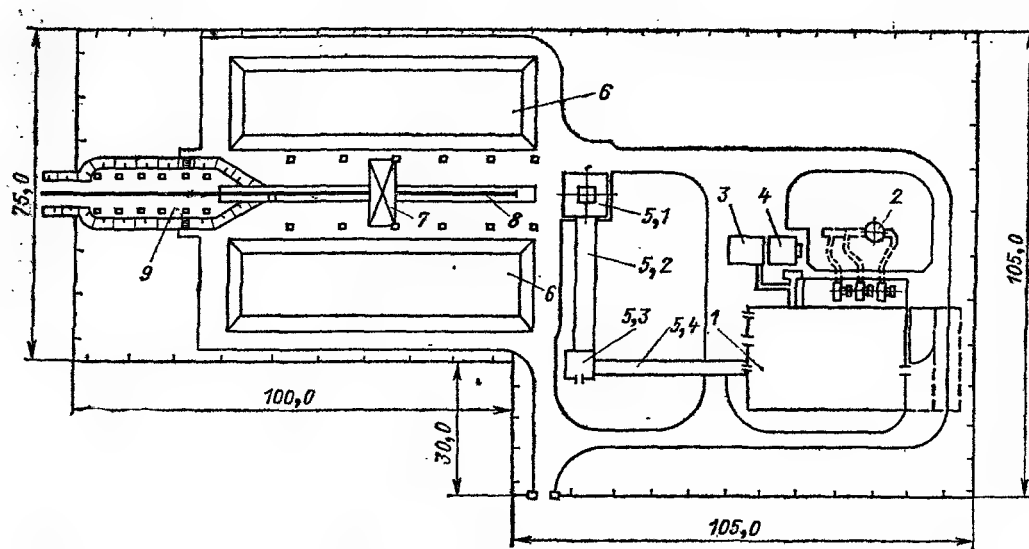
Схема генерального плана котельной теплопроизводительностью 60 Гкал/ч.
